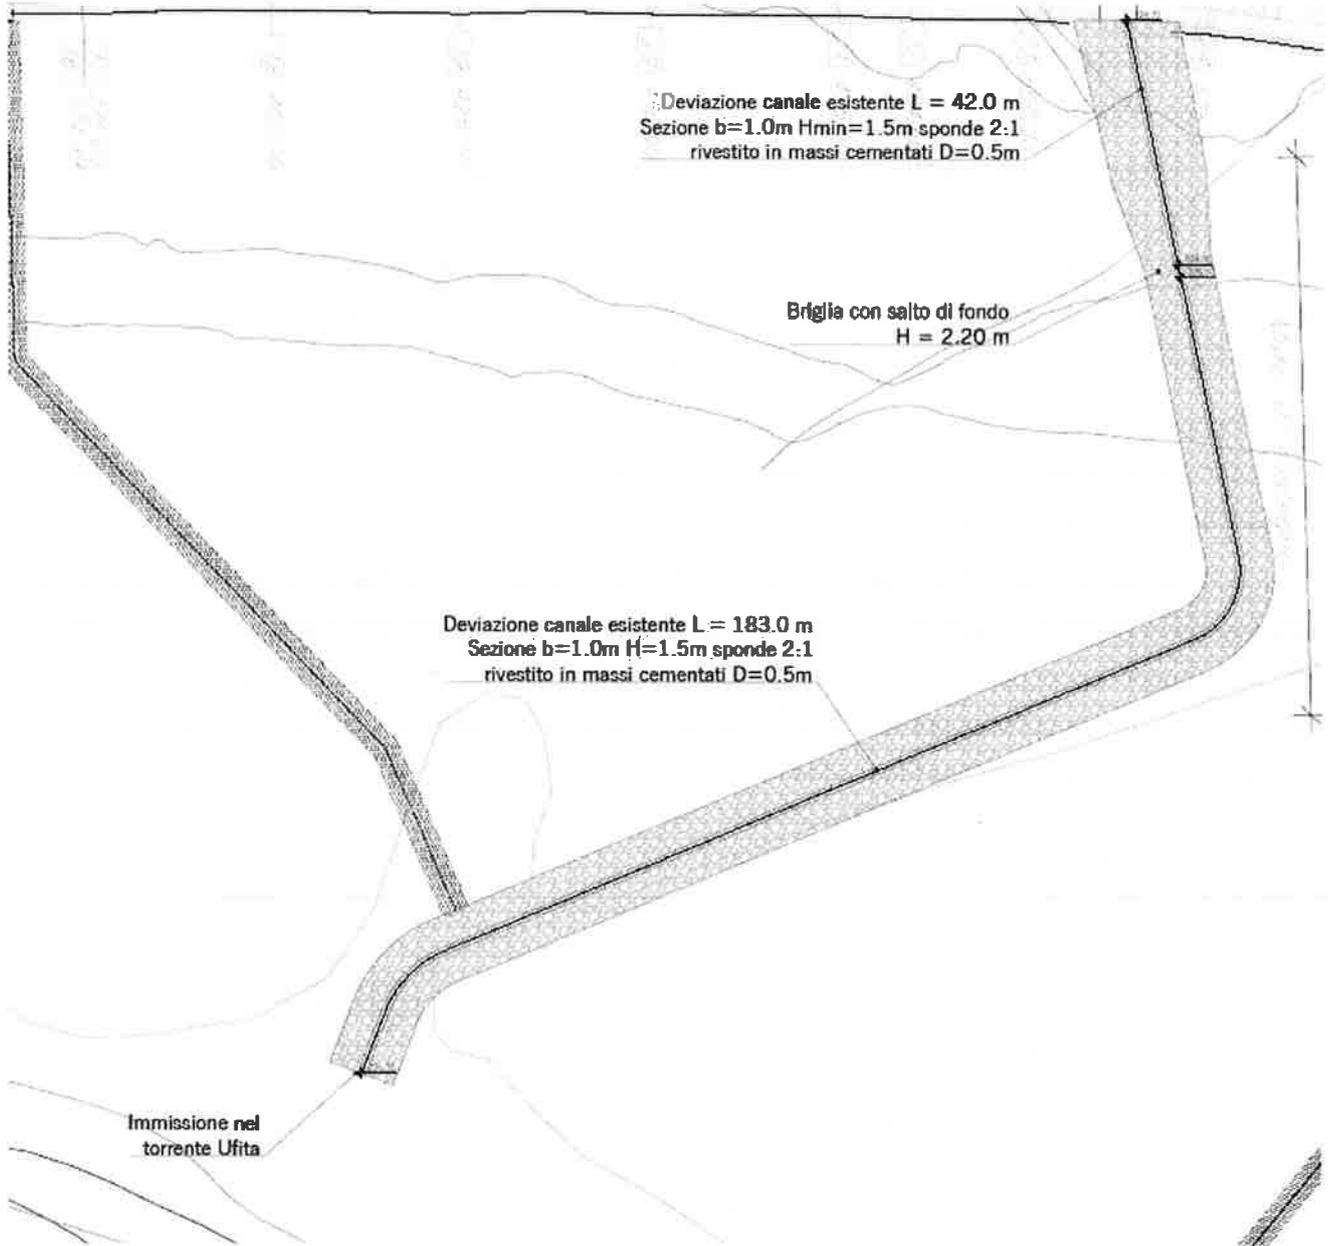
Inalveazione IN01 – tratto di valle. Pianta
